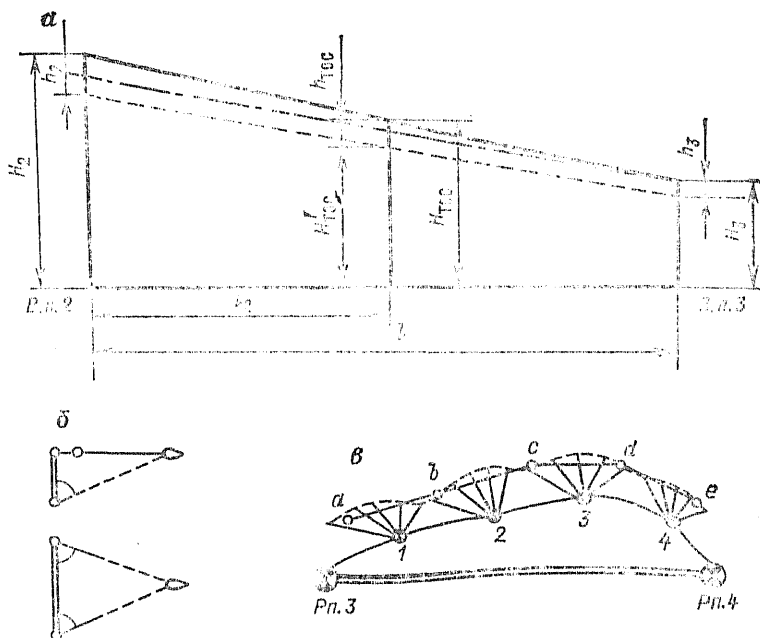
Схемы геодезических работ при изысканиях гидротехнических сооружений:
